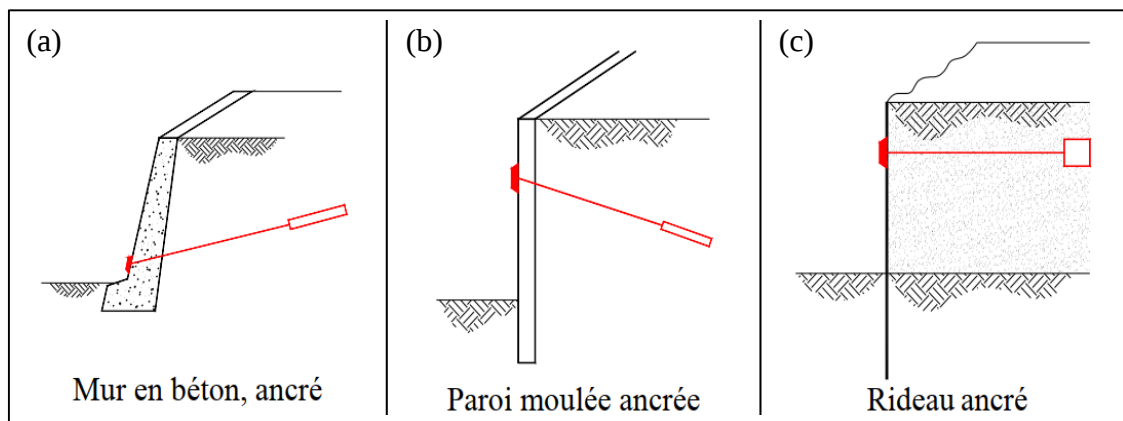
Type d'ouvrages de soutènement - poussée reprise par ancrage
